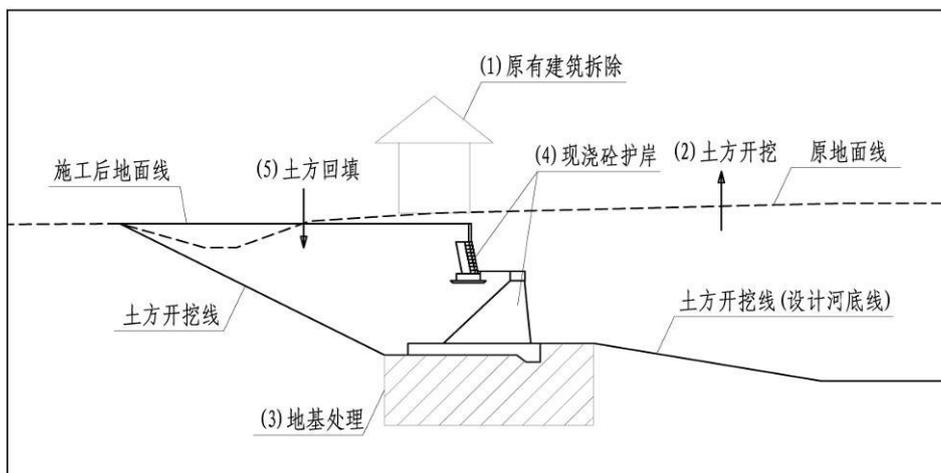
平地开河段护岸施工示意图 (图中序号表示施工顺序)
